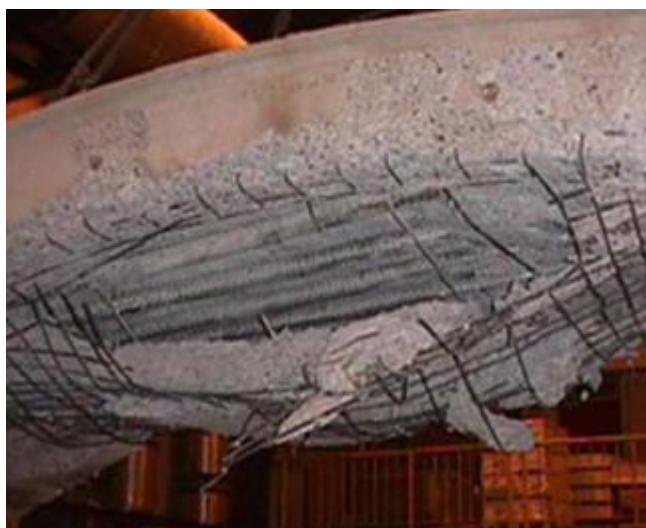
Degradação do elemento estrutural de concreto devido à ocorrência de spalling pela exposição a elevadas temperaturas
